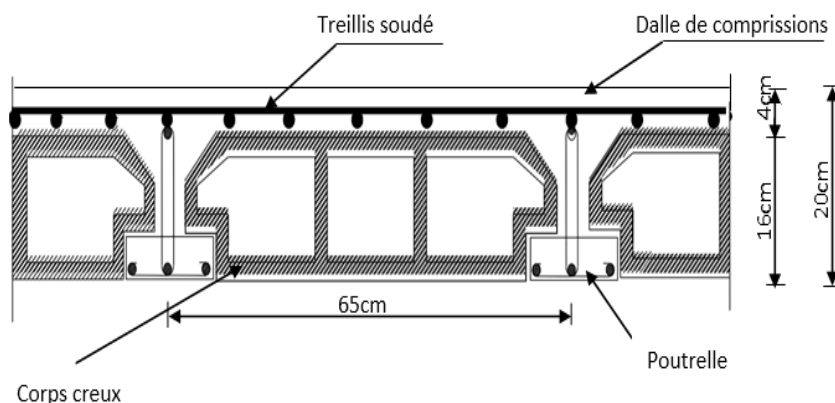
Plancher en béton armé avec poutrelles et hourdis
